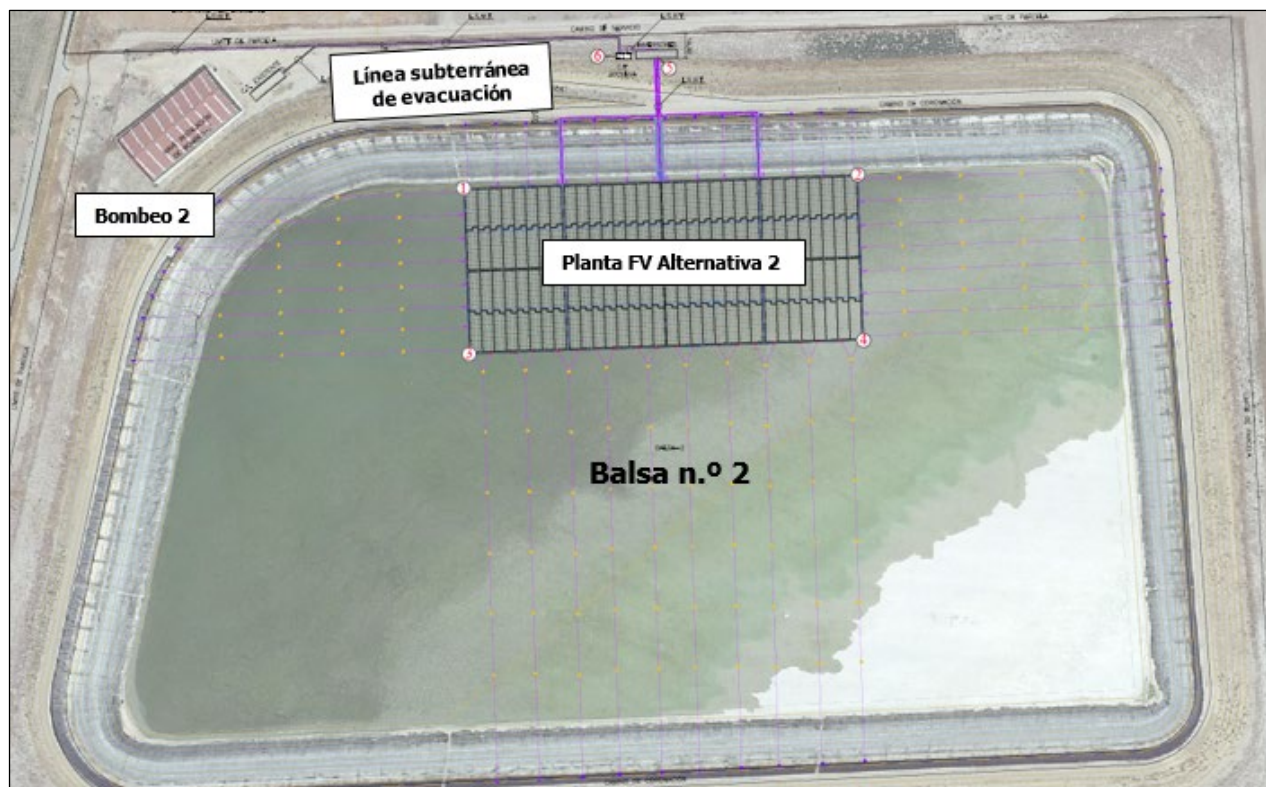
Ubicación de la planta fotovoltaica en la Alternativa 2
